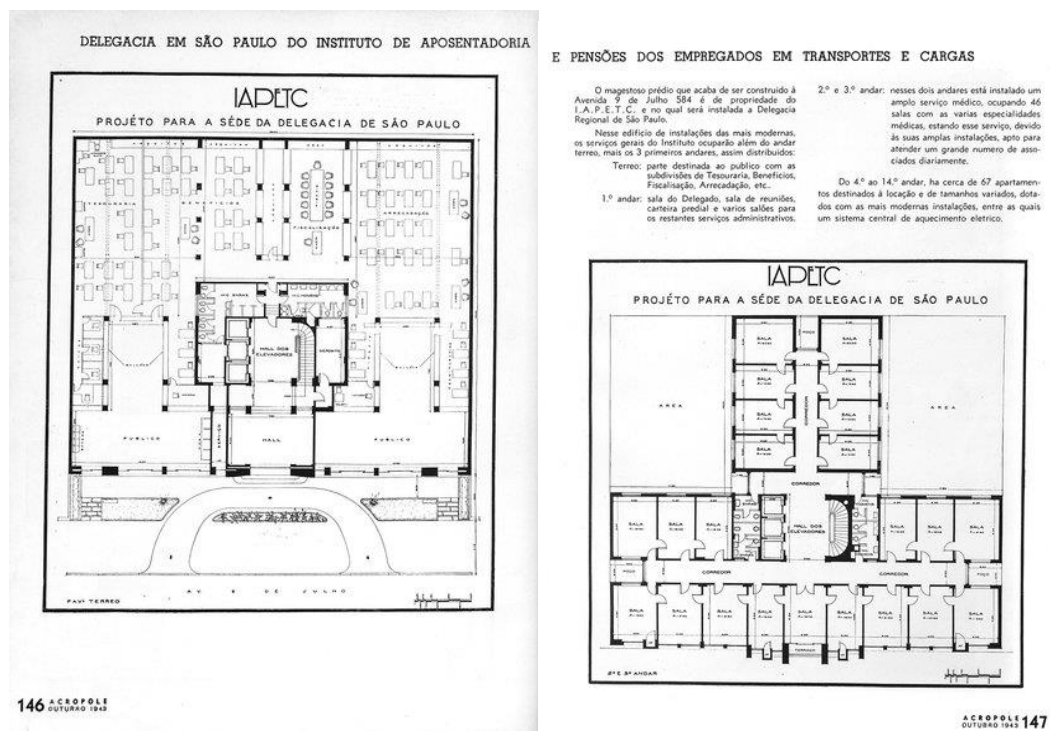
Projeto planta Térreo, 2º. E 3º. Pavimentos Edifício IAPETC
